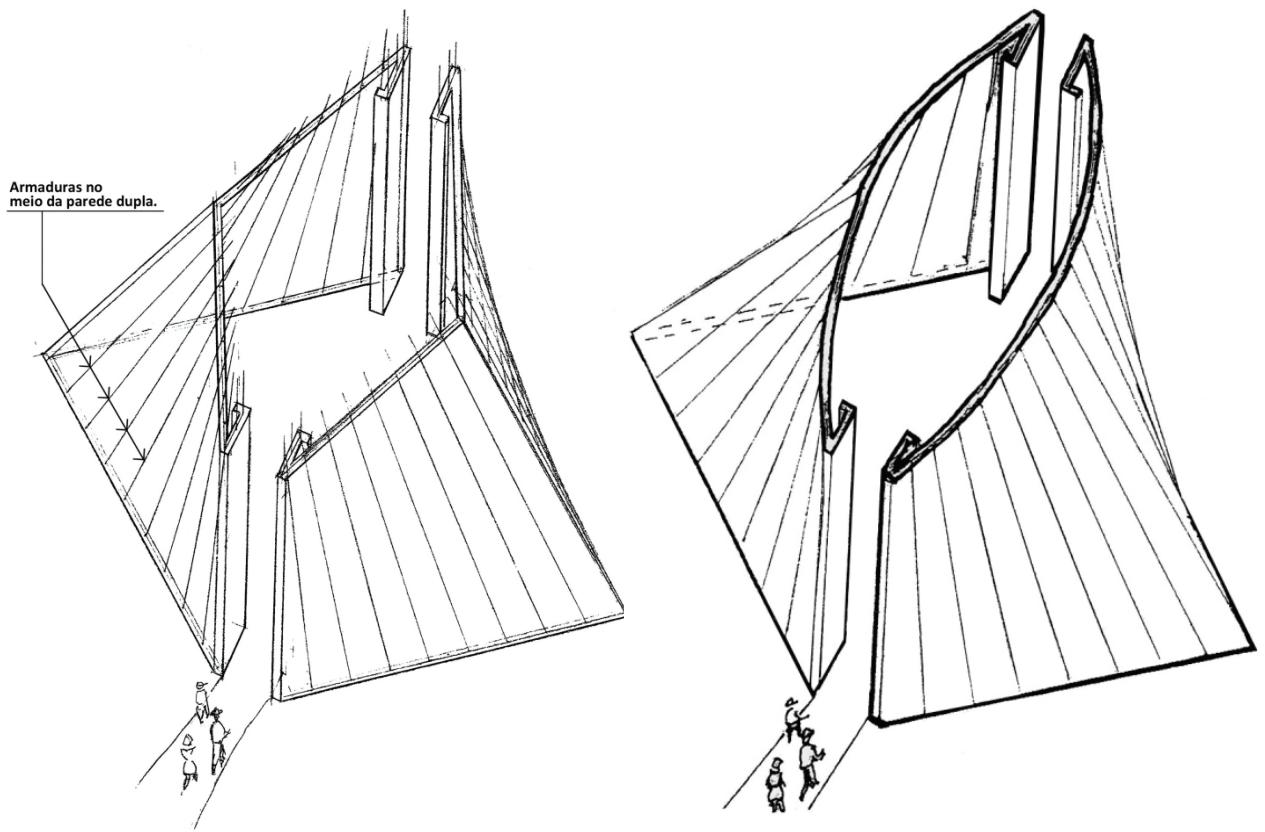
Esquema do formato das paredes, a base reta da parede se cruza, ou seja, não é paralela à reta do topo da parede. As armaduras são retas que guiam o levantamento da parede. (*-5).
